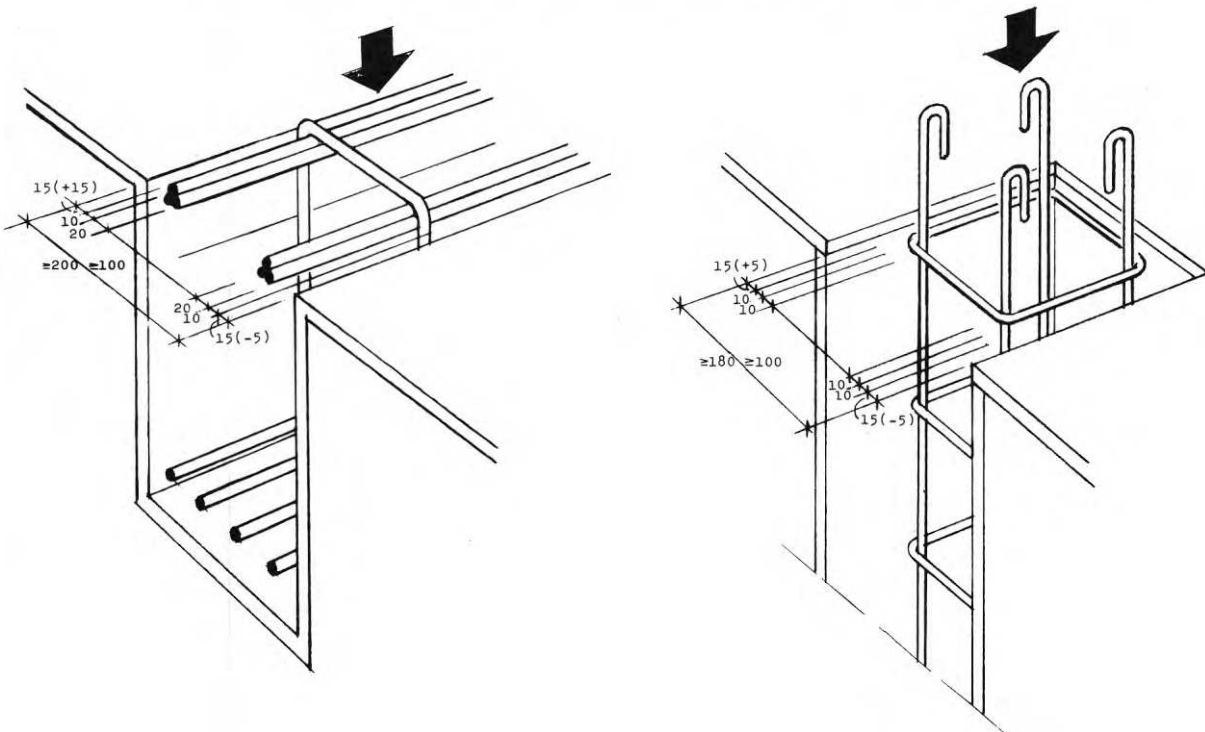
Minsta avstånd mellan armeringsstängerna i balk.
